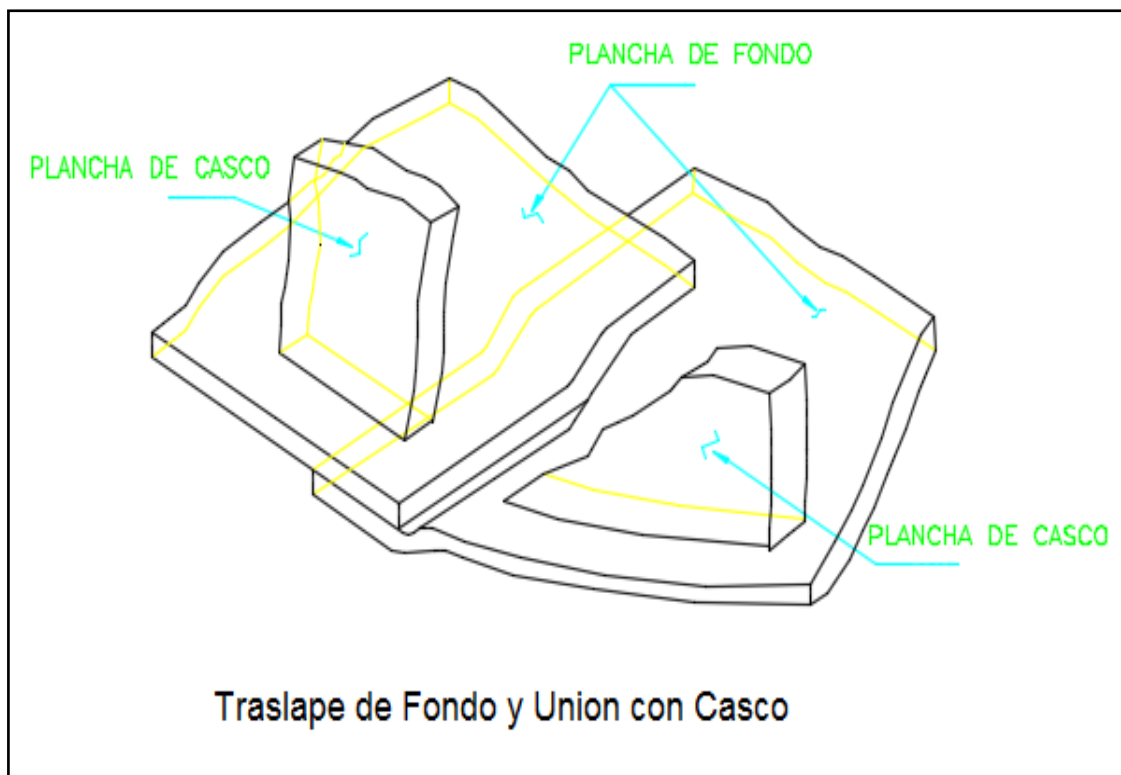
Soldadura en T, Unión Fondo y Casco.
